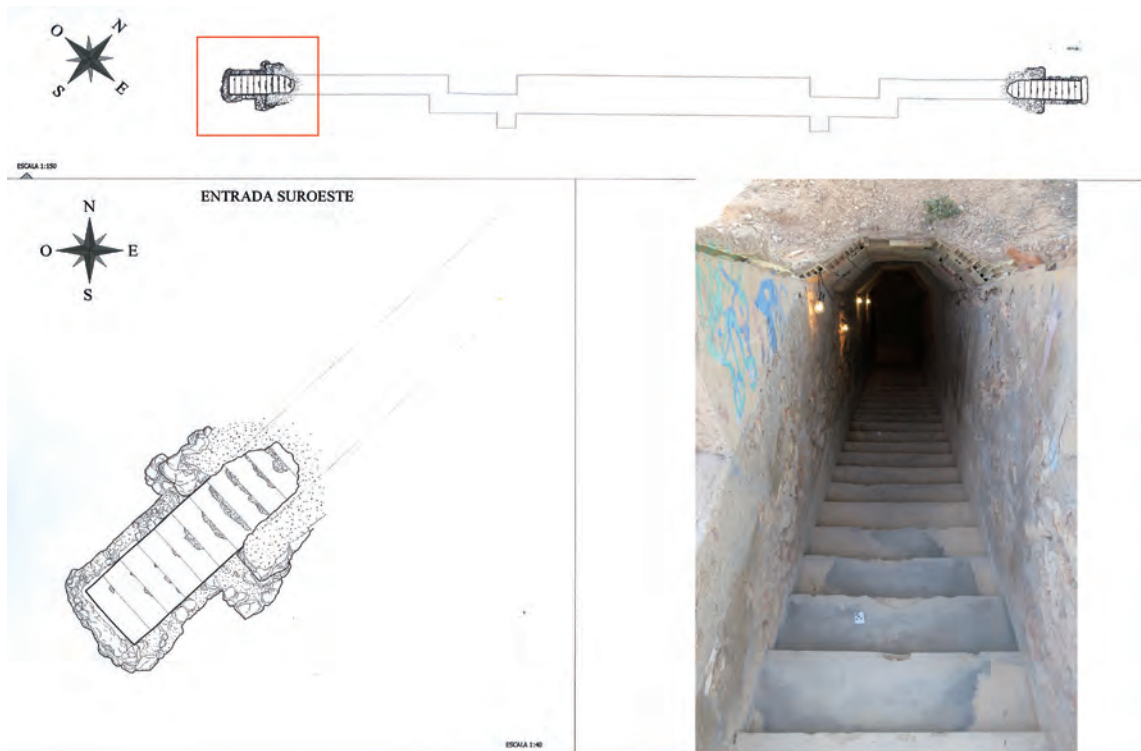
Planta del refugio y entrada suroeste (Foto Alebus).
